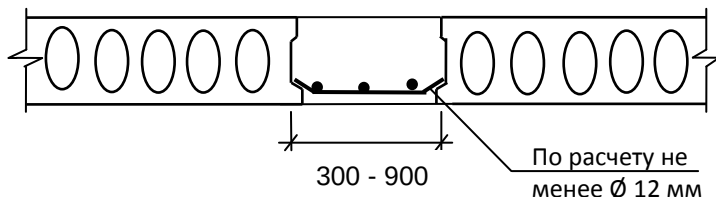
Конструкция монолитных участков для перекрытий из плит типа ПБ для ширины 300 – 900 мм.
